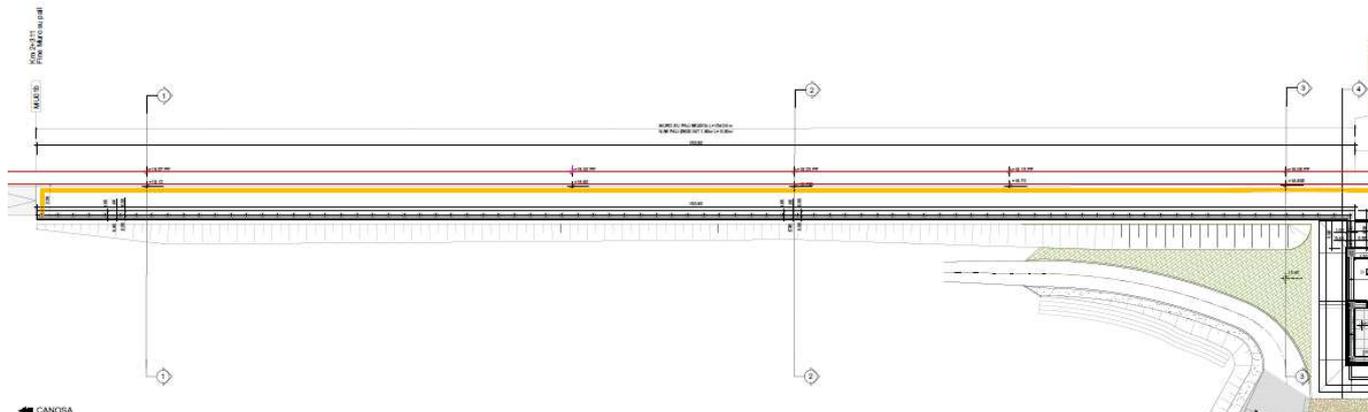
Muro di sostegno su pali – Pianta lato ovest del fabbricato.
